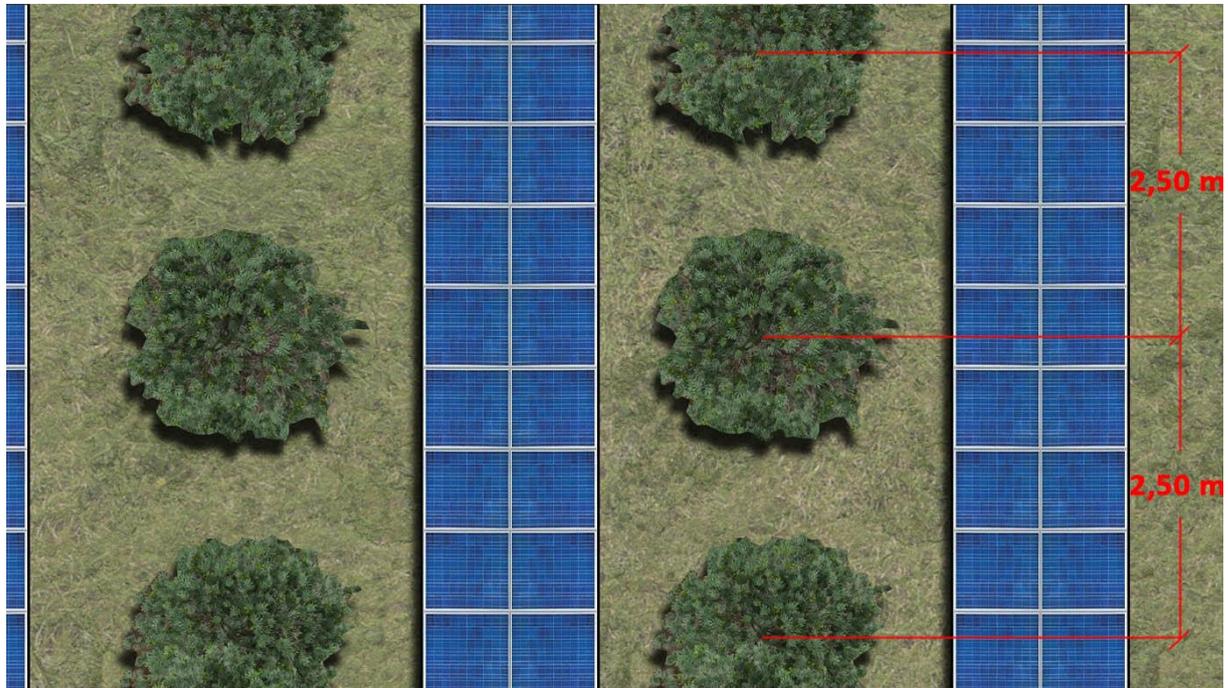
Tipologico – Vista Planimetrica dell’impianto Olivicolo.
